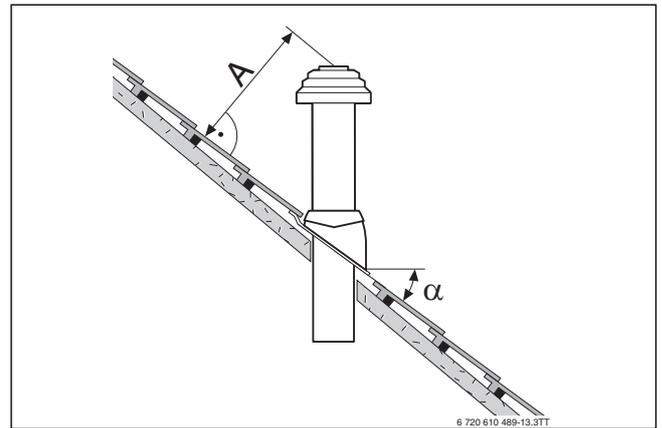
Abstandsmaße und Dachneigungen bei Schrägdach
